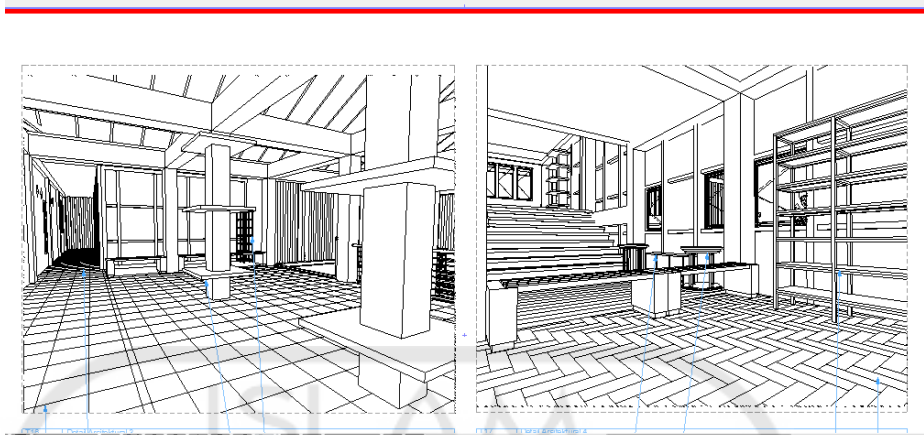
Rancangan Detail Arsitektural Khusus Bangunan 3
